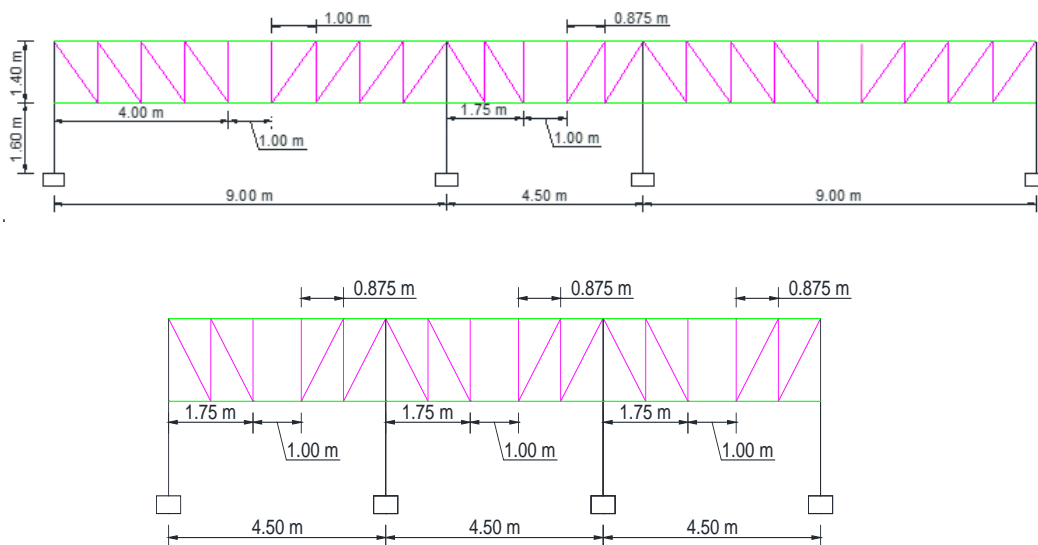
Configuración de los pórticos con viga reticulada y el segmento especial Vierendeel en la dirección Y.
